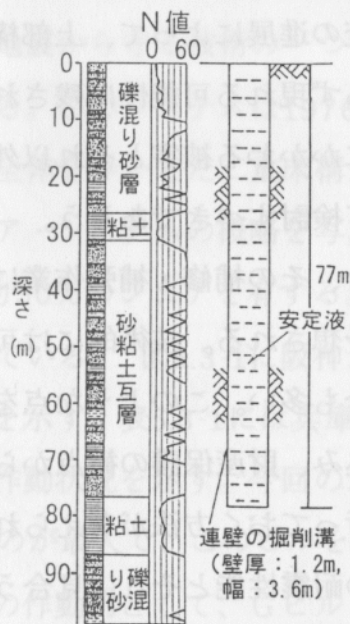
地震時に施工中の連続地中壁の掘削溝と施工地点の地層構成
